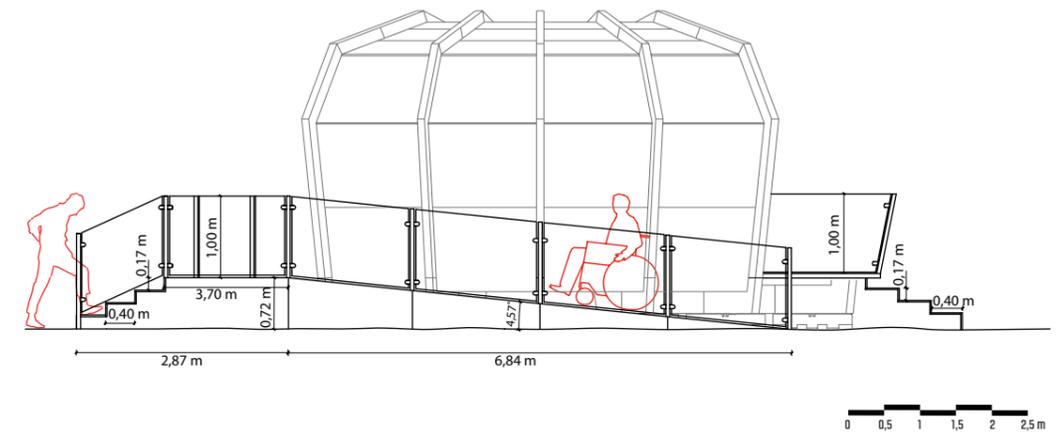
SCHEMA PLANIMETRICO DEGLI ELEMENTI PER L'ACCESSIBILITÀ
